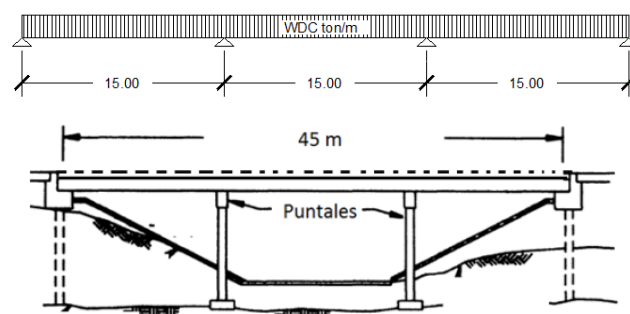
Etapa 1. Viga apuntalada y losa sin resistencia
